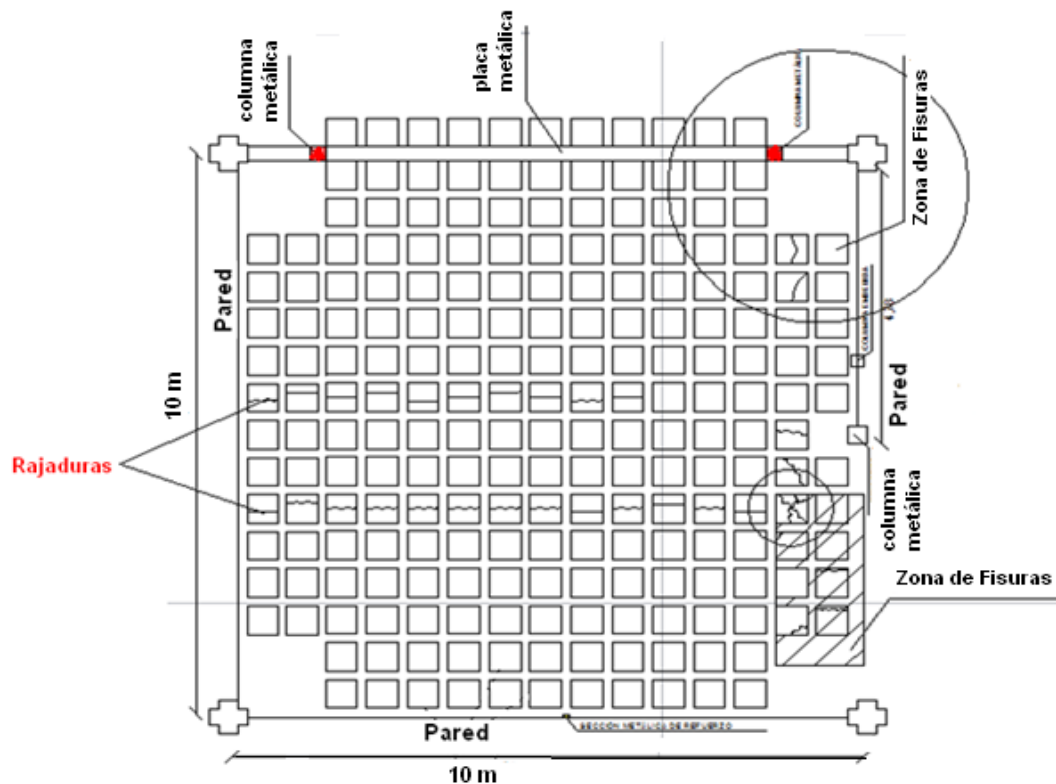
Levantamiento de fisuras y zonas de apoyo
